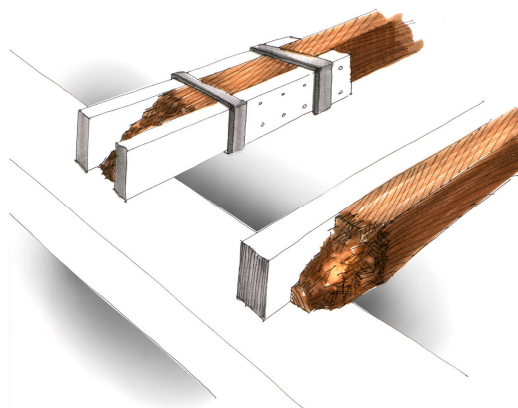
Utilização de novos elementos em madeira maciça no reforço de uma estrutura existente
